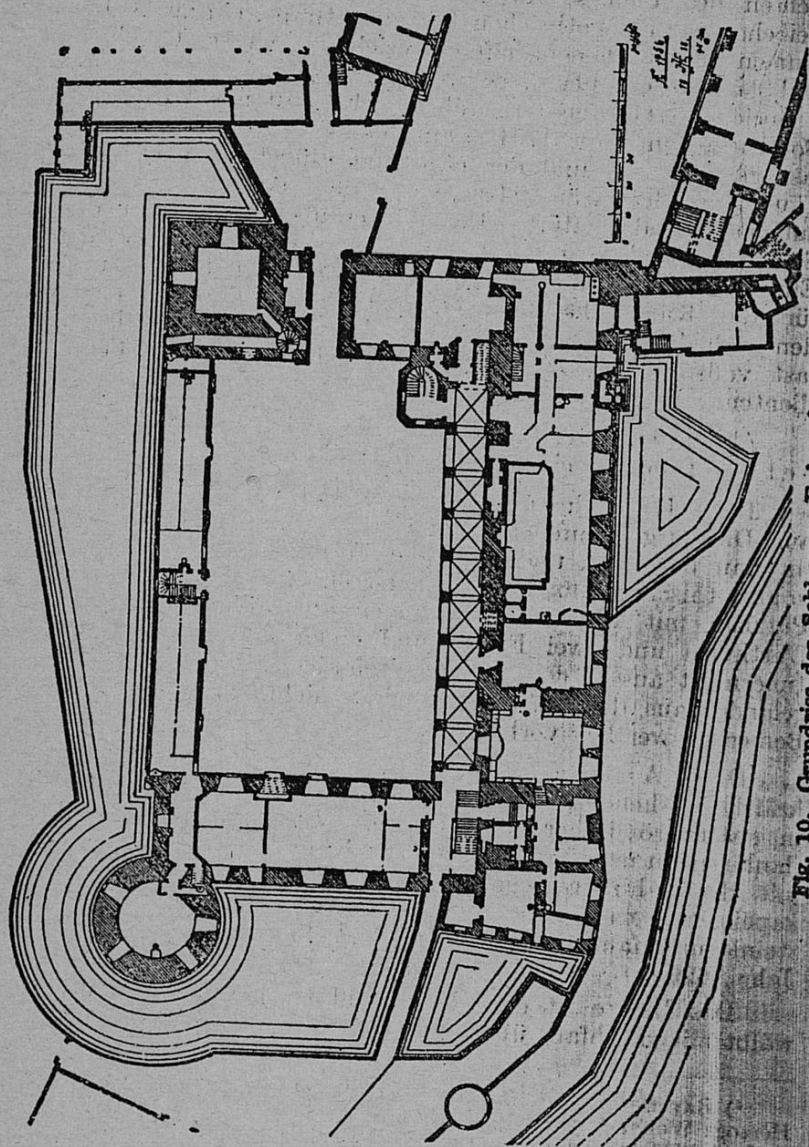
Grundriss des Schlosses. Erdgeschoss. 1756.
